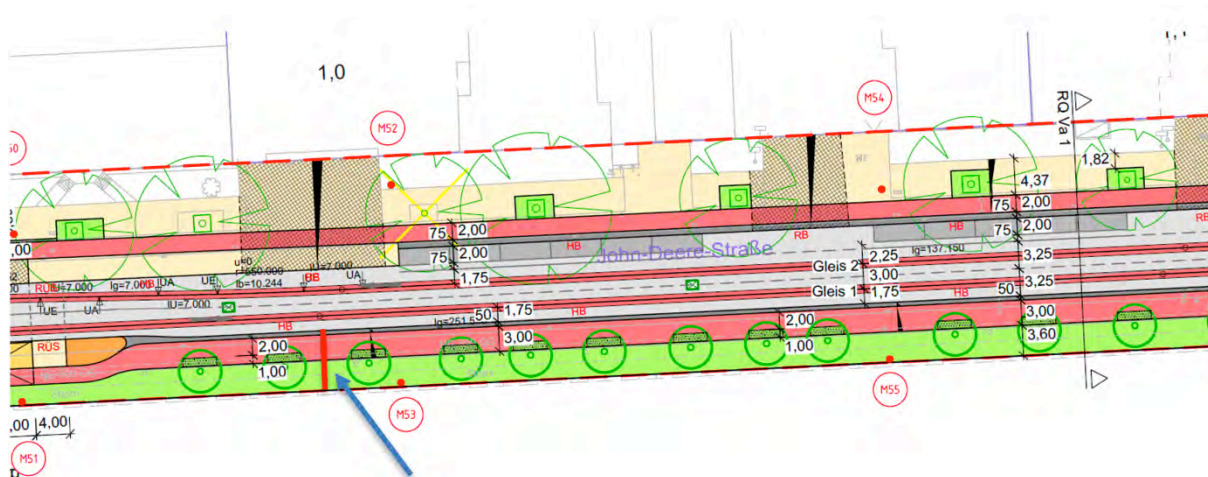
Lageplan der durchgeführten Suchschachtung vom 09.11.2023
